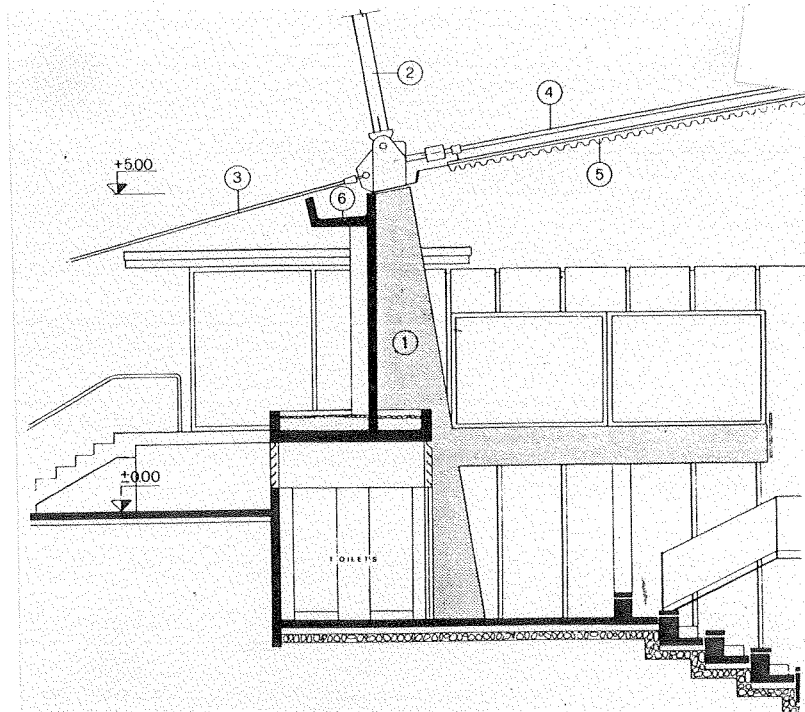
Corte transversal no ponto mais baixo da cobertura; 1) Estrutura em concreto armado; 2) Montante articulado em aço; 3) Tirante ancorado no solo; 4) Cabo tensor; 5) Cobertura; 6) Canal de recolhimento de águas pluviais.
